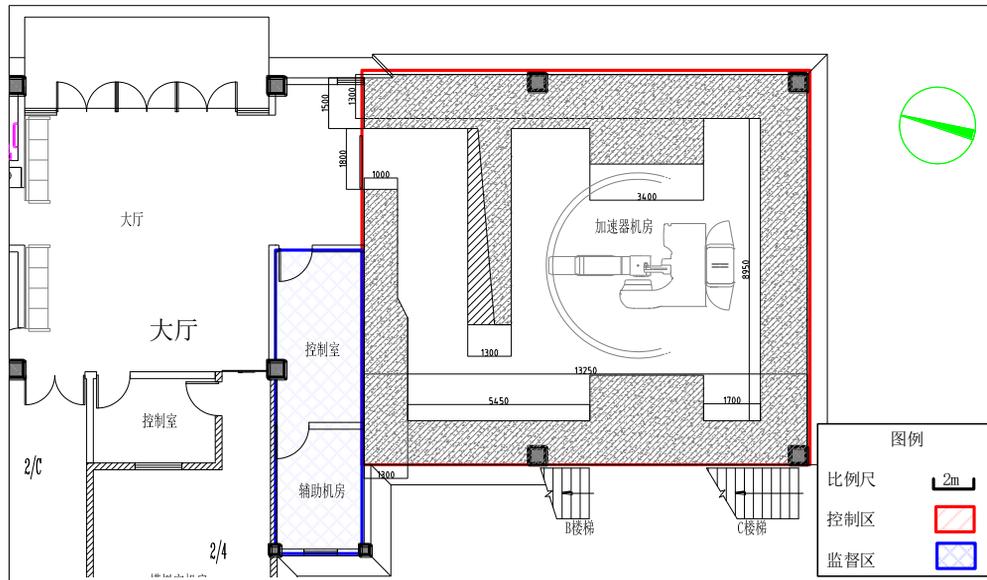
本项目医用直线加速器机房平面布置及分区示意图
